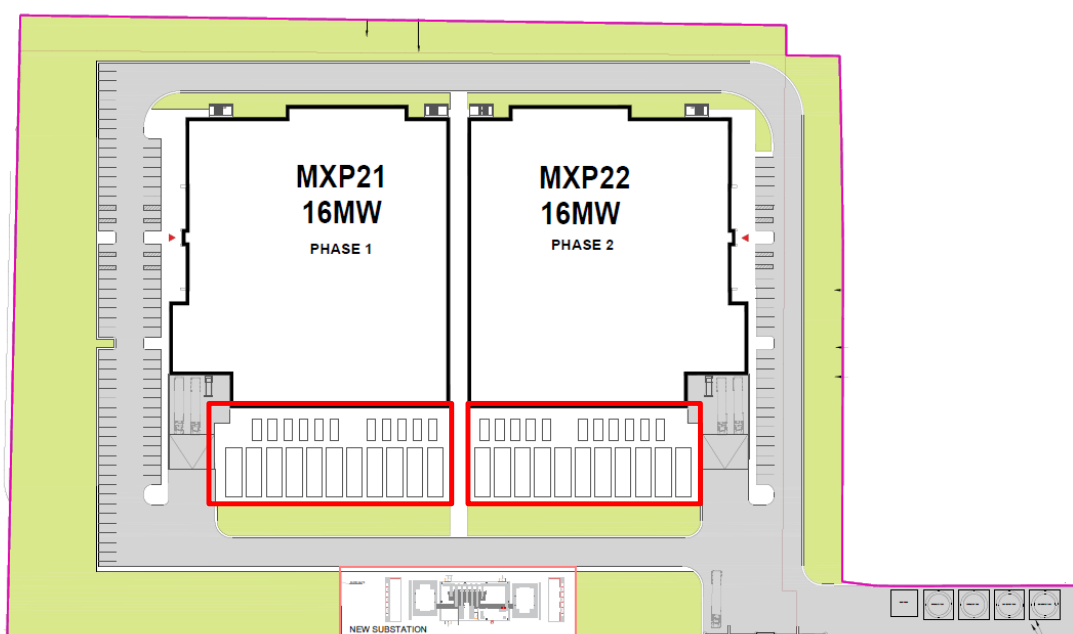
Planimetria generale di progetto del sito con indicazione dell'impronta degli edifici MXP21 e MXP22
